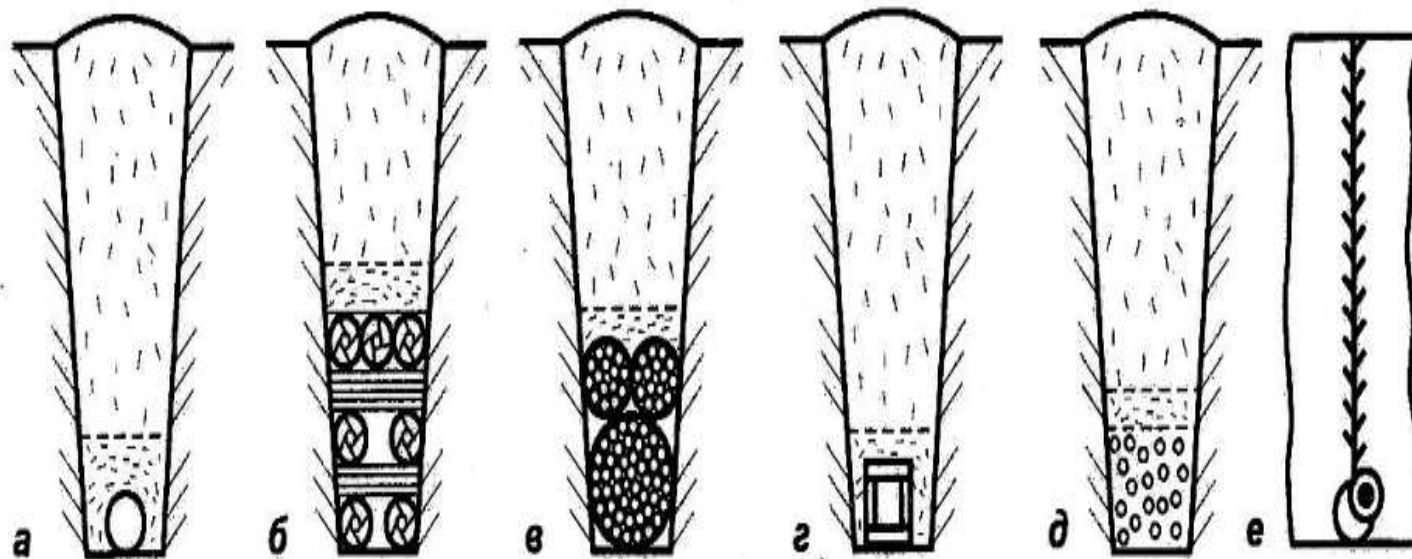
Виды дренажа: а - гончарный; б – жердяной; в – фашинный; г – деревянный трубчатый; д – каменный; е - кротовый
